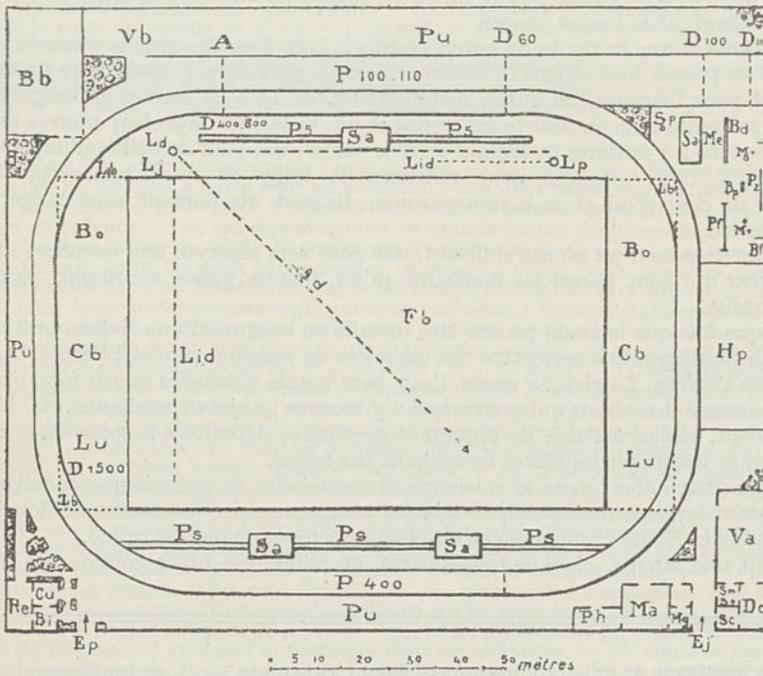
Plan d'un stade moderne de 160 × 130 m. (d'après de Bellefon).
